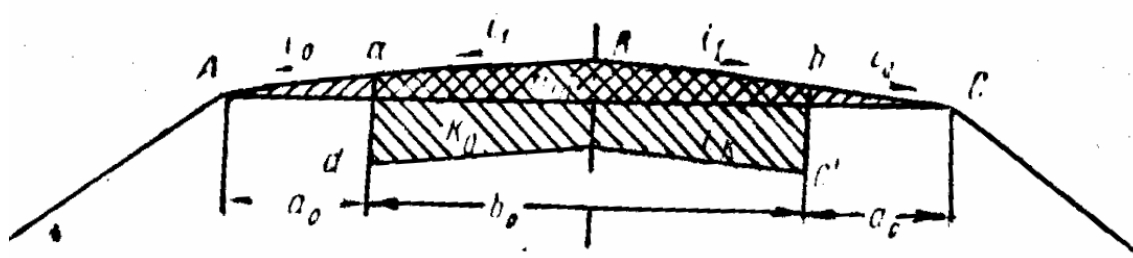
Поперечное сечение земляного полотна при устройстве корыта
